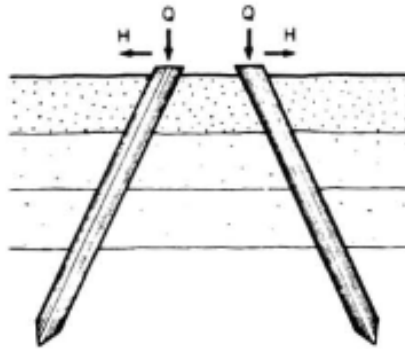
Pilotes inclinados, Manual de diseño y construcción de pilas y pilotes, SMMS, 1983.
